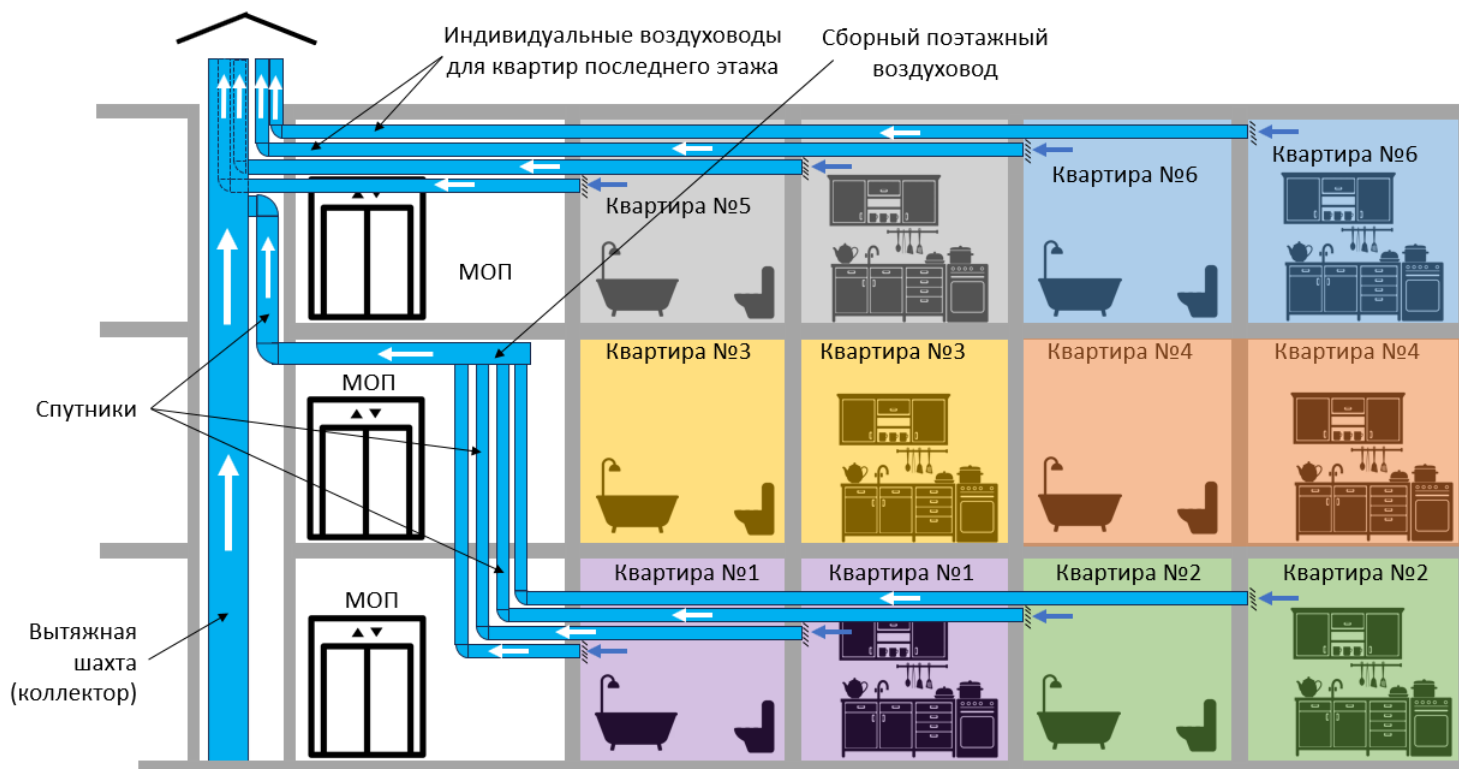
Сборный горизонтальный поэтажный воздуховод, к которому подключаются несколько квартир нижележащего этажа. Для вентиляции квартир последнего этажа используются индивидуальные воздуховоды. Эта схема очень популярна в современных ЖК, в т.ч. в высотных
